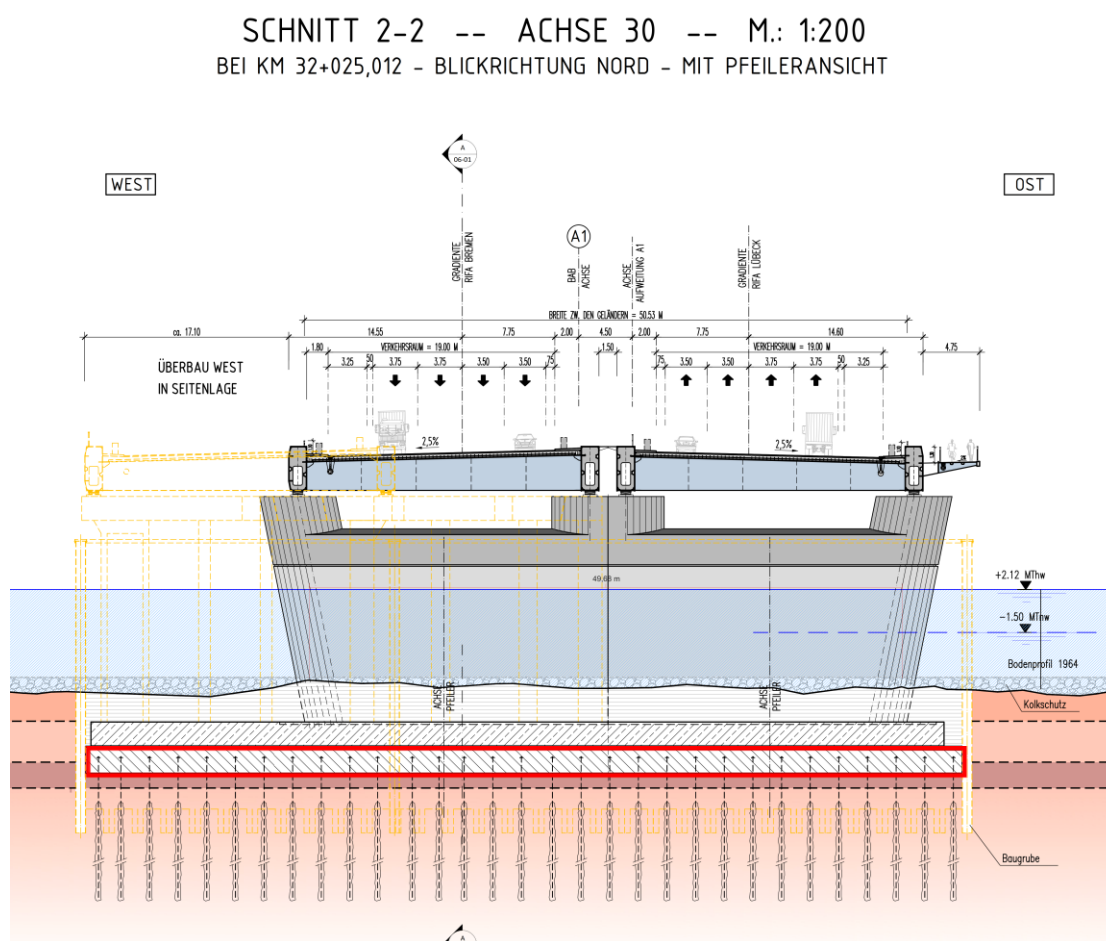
Schnitt 2-2 (Achse 30) bei Bau-km 32+025,012 mit der eingebrachten rückverankerten Unterwasserbetonsohle (rot) nach Rückbau der bauzeitlichen Pfeiler – Blickrichtung Nord (Unterlage 15.1/3)
